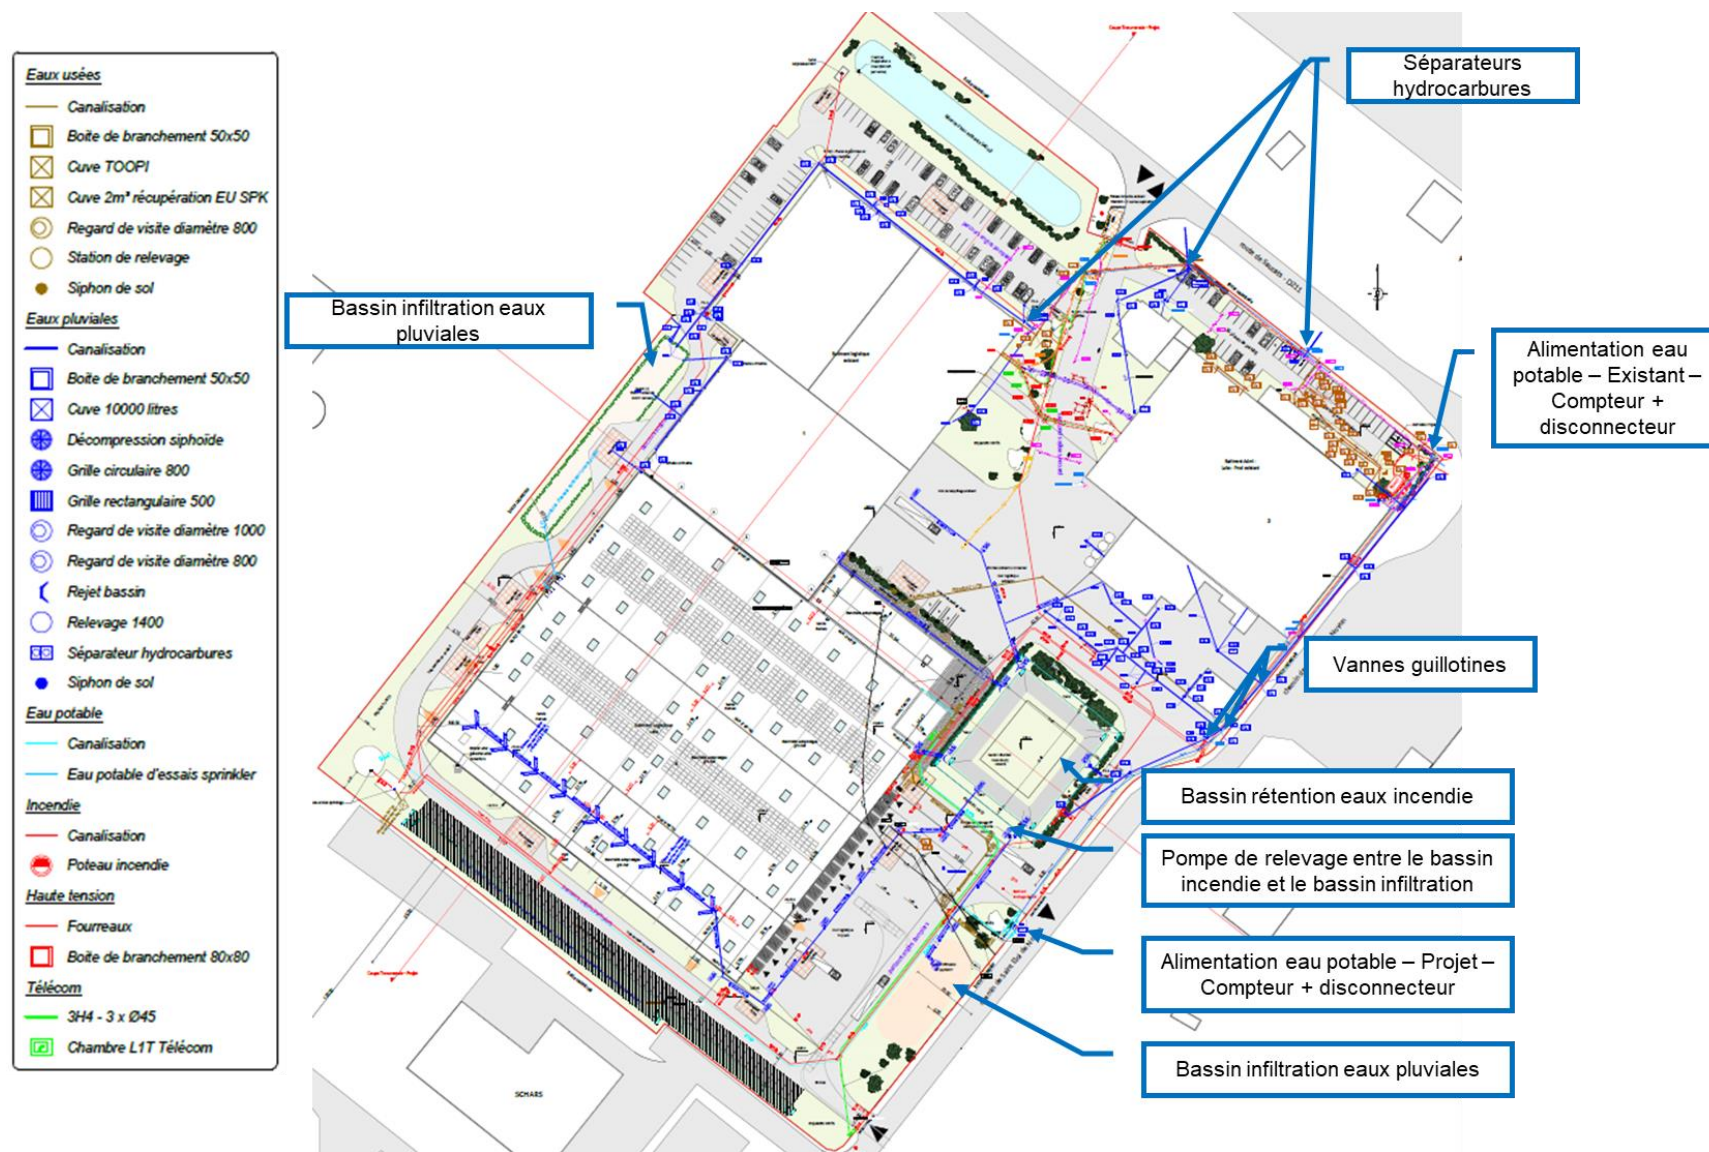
Plan de masse du projet et réseau d'eaux pluviales interne
